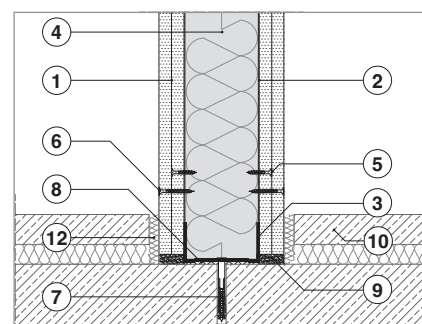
Conexiunea peretelui cu planșeu din beton armat sau șapă uscată cu rost uscat la nivelul peretelui
